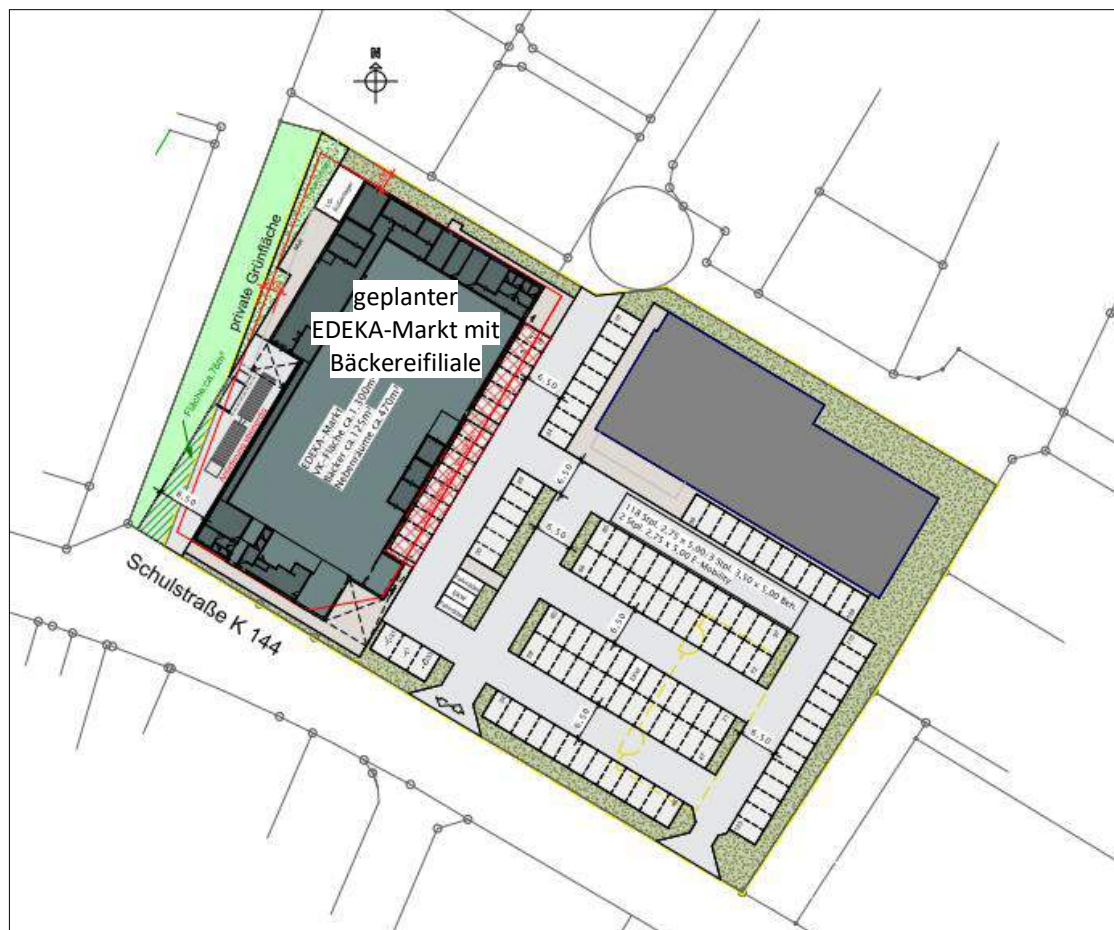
Lageplan mit vorgesehener Aufteilung des Grundstückes
